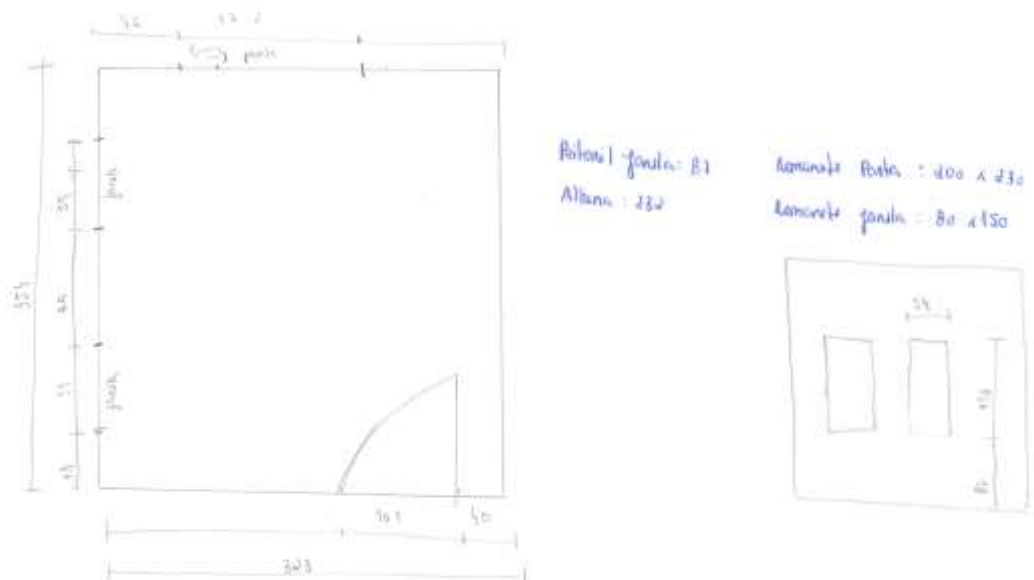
Levantamento das dimensões da sala de piano – Planta à mão levantada
